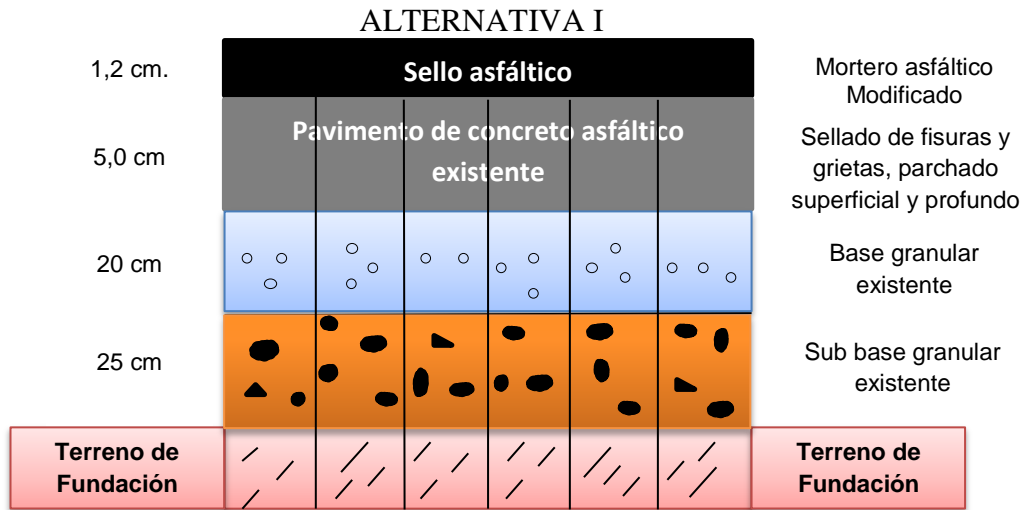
Solución alternativa I del sub tramo II. Sección estructural del pavimento, sellado de fisuras y grietas, parchado superficial y profundo en calzada y colocación de un mortero asfáltico modificado de  $e=1,2$  cm.
